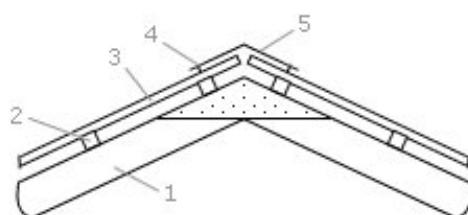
Крепление коньковых изделий на кровле: 1 – стропило; 2 – обрешётка; 3 – шифер; 4 – гвоздь или шуруп длиной 100 мм; 5 – конёк из кровельной стали
